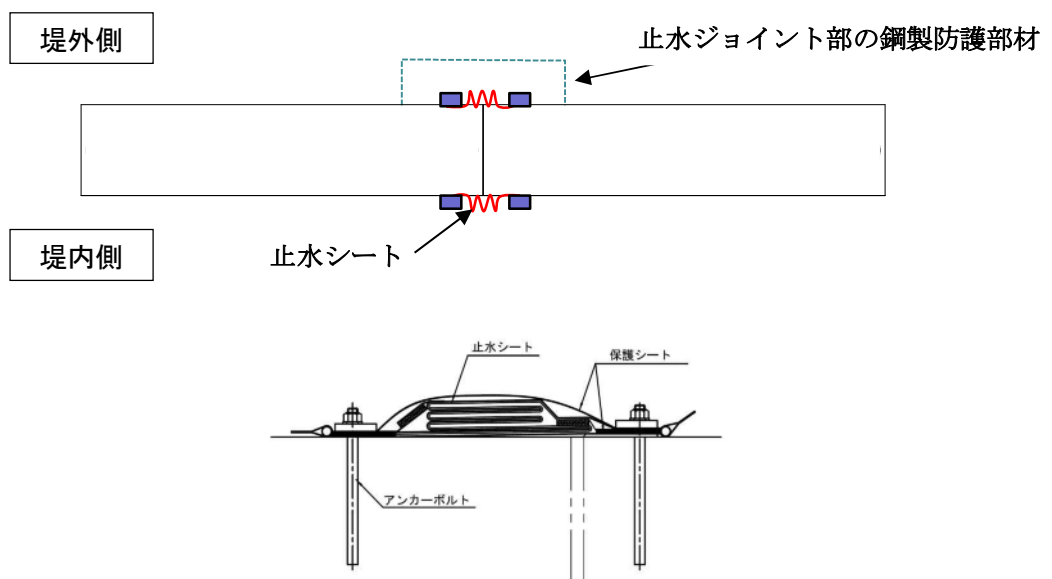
鉄筋コンクリート防潮壁 平面図
